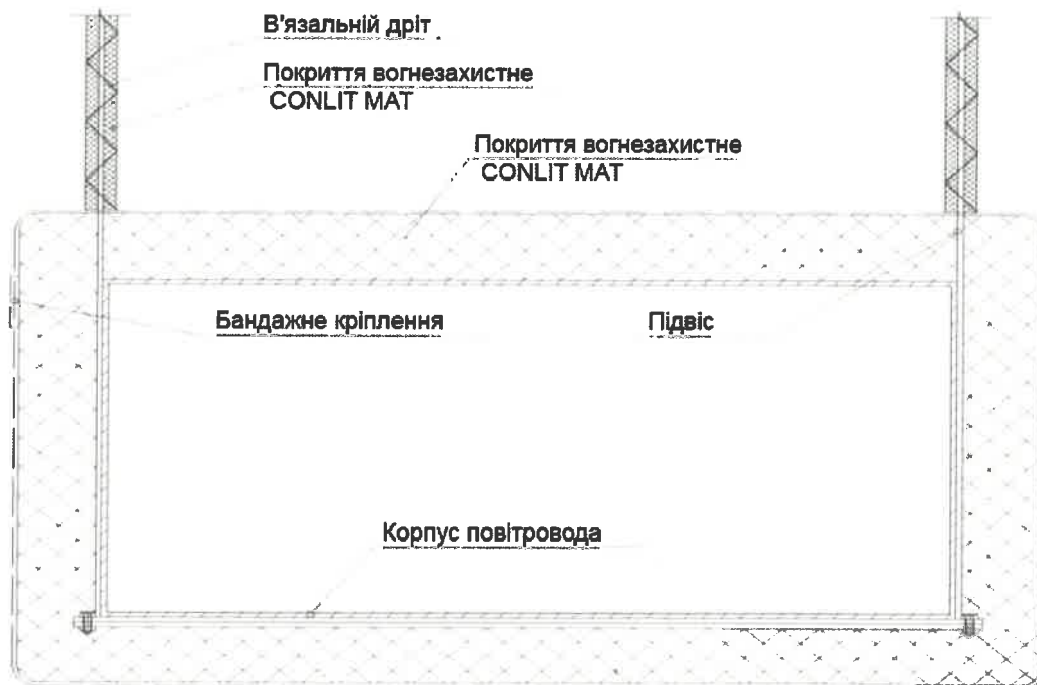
Принципова схема перетину повітропроводом будівельної конструкції
